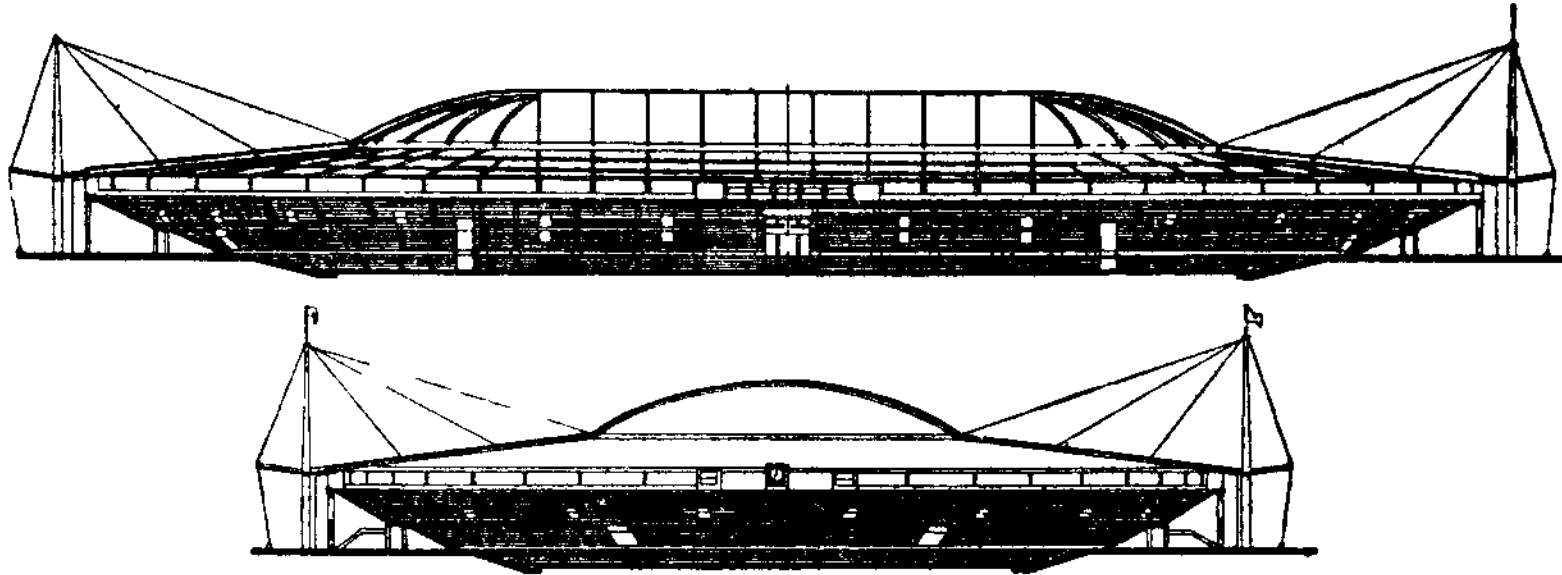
Вантовая консольная система перекрытия стадиона «Динамо» (проект)
